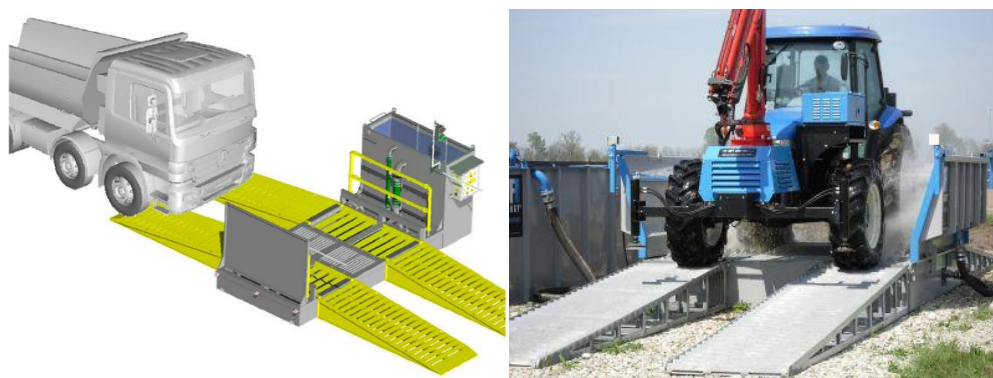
Impianto di lavaggio mezzi tipo B nelle aree di lavorazione locali
